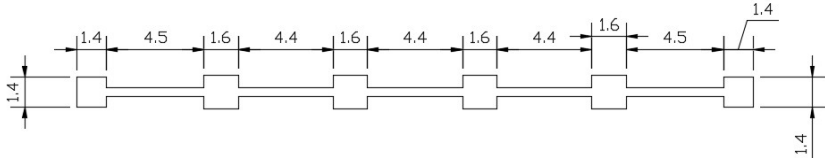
Vista en planta de los elementos de cimentación con sus dimensiones
